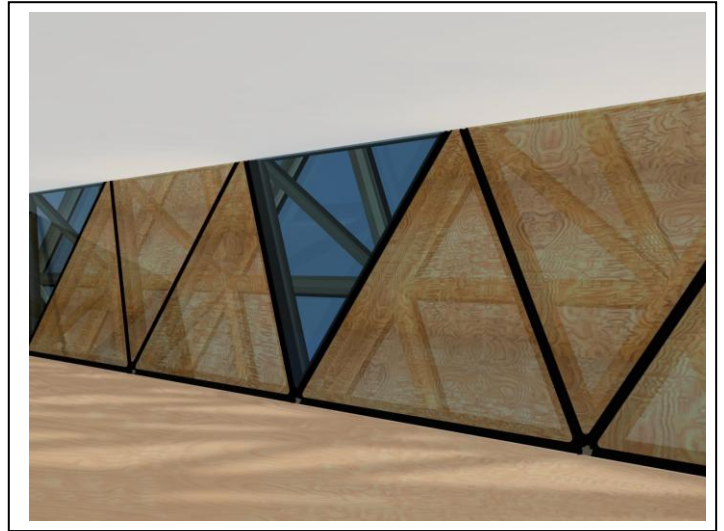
Muestra de fachada elaborada con vidrio laminado con chapa de madera
